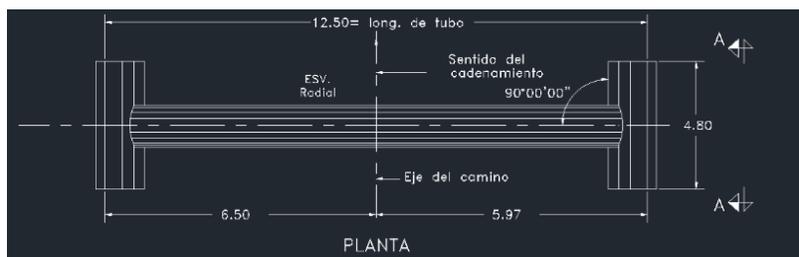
Características de las obras de drenaje a implementar en el proyecto (planta).
